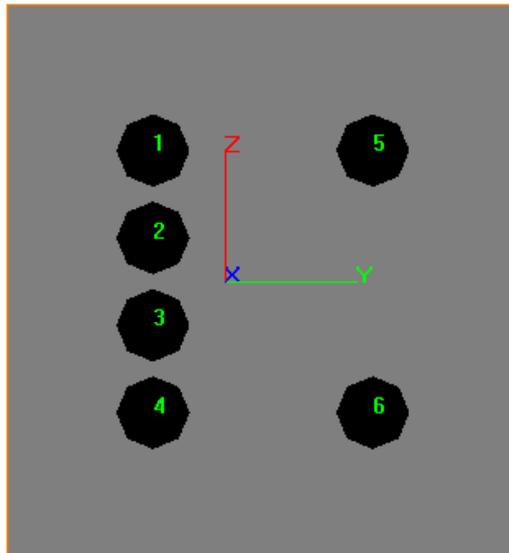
Schema Group della palificata - ampliamento fondazione su pali trivellati
